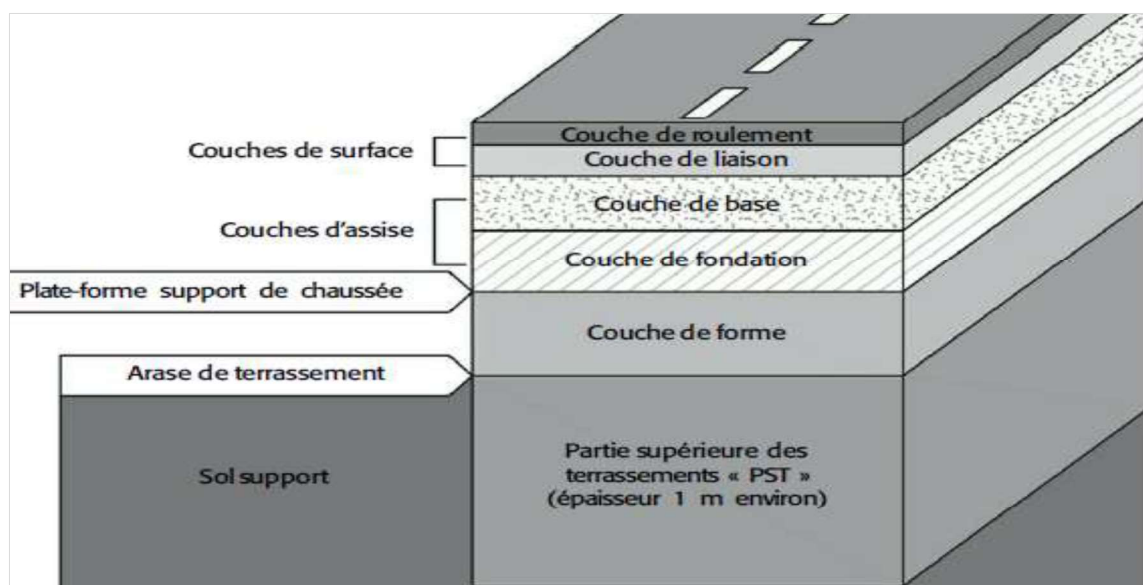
Coupe type des couches d'une chaussée (LCPC & SETRA, 1998)
